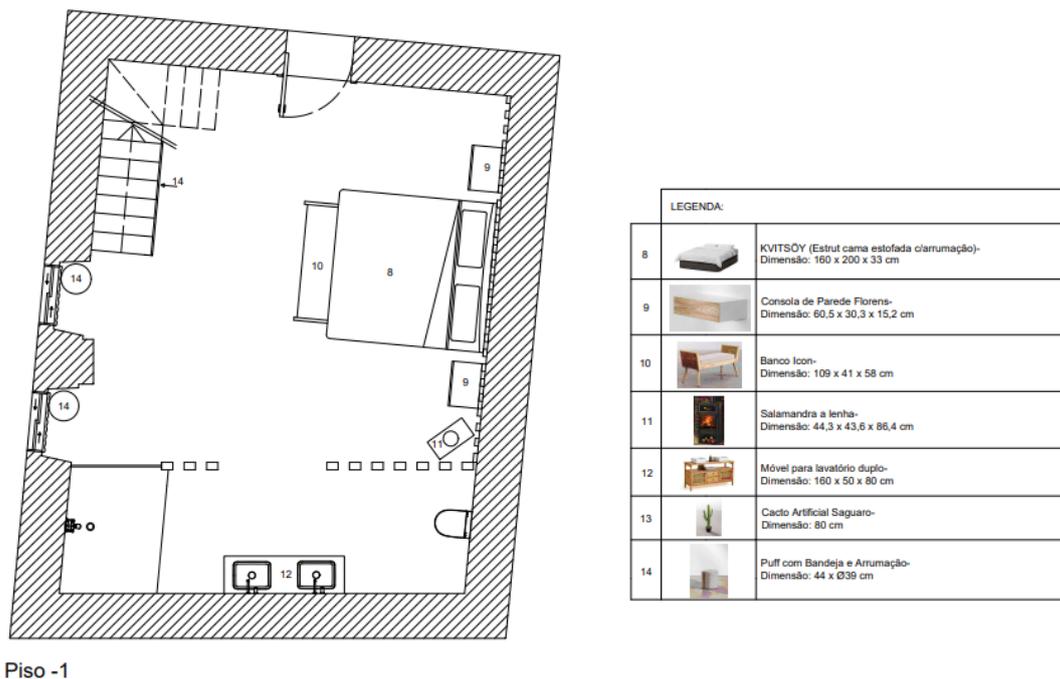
Planta de mobiliário e equipamento piso -1. Fonte: Maria Leonor.
